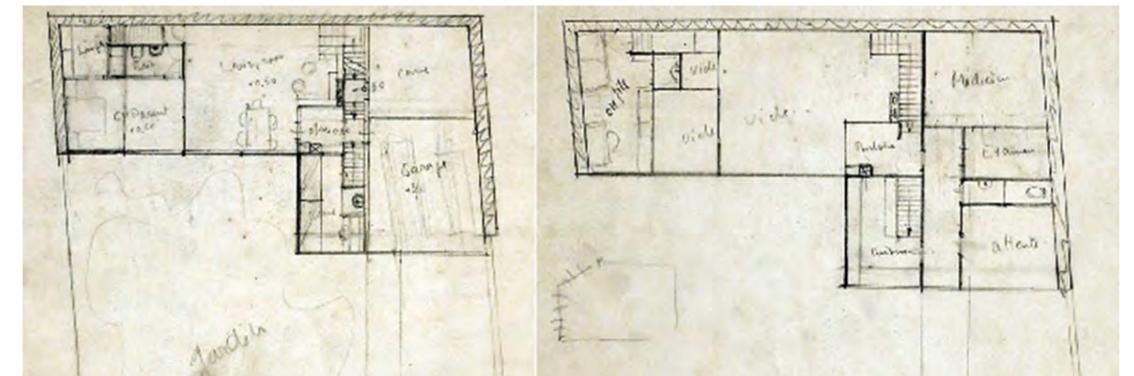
FLC 18639 y FLC 18642: Plantas baja y primera de la propuesta con cubierta inclinada a dos aguas.
